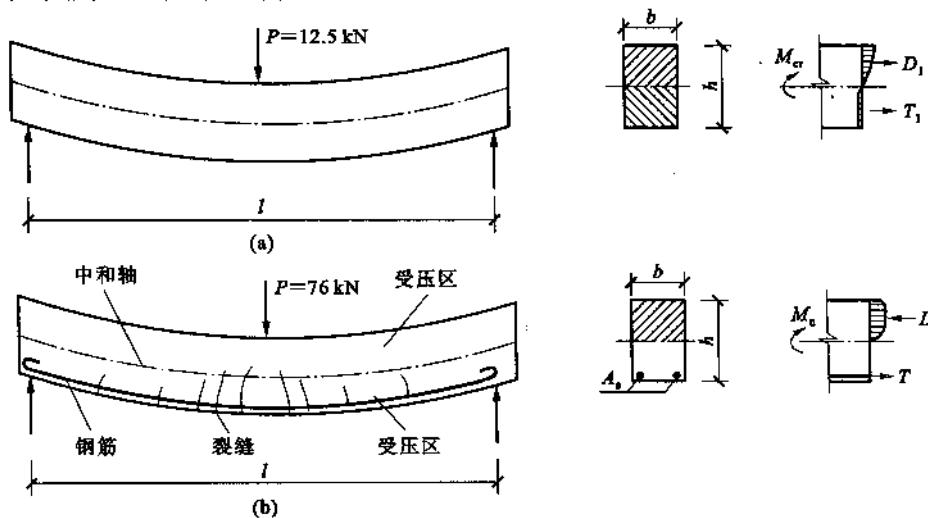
素混凝土及钢筋混凝土简支梁的承载力
